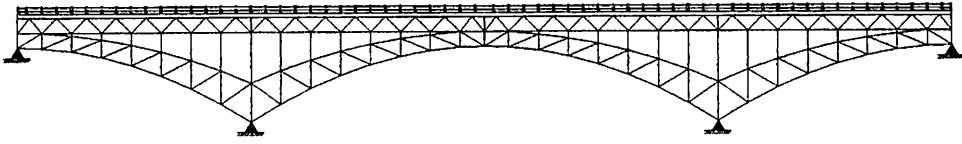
Jembatan Busur bertantai kendaraan rendah
